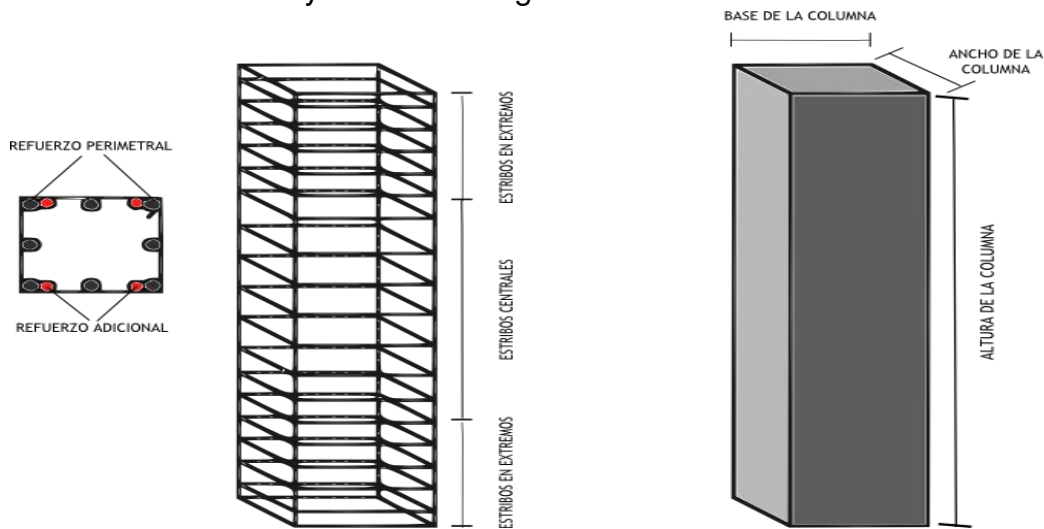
Columna estructural elaborado por ETM, con el programa AutoCAD
